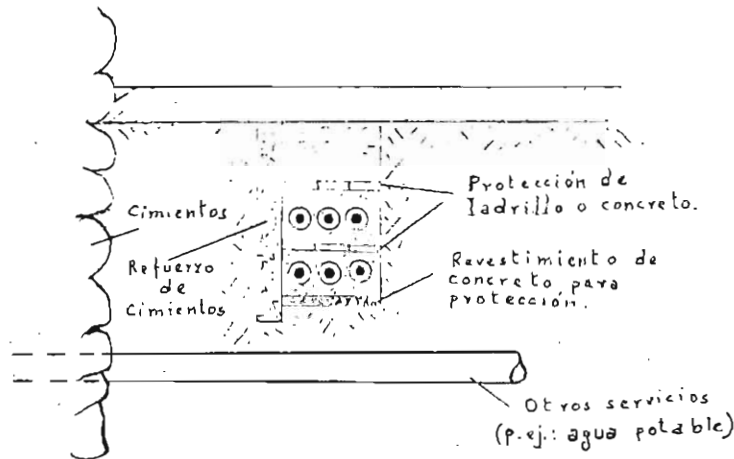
Revestimientos de protección de cables contra otras instalaciones y refuerzo de estructuras.
